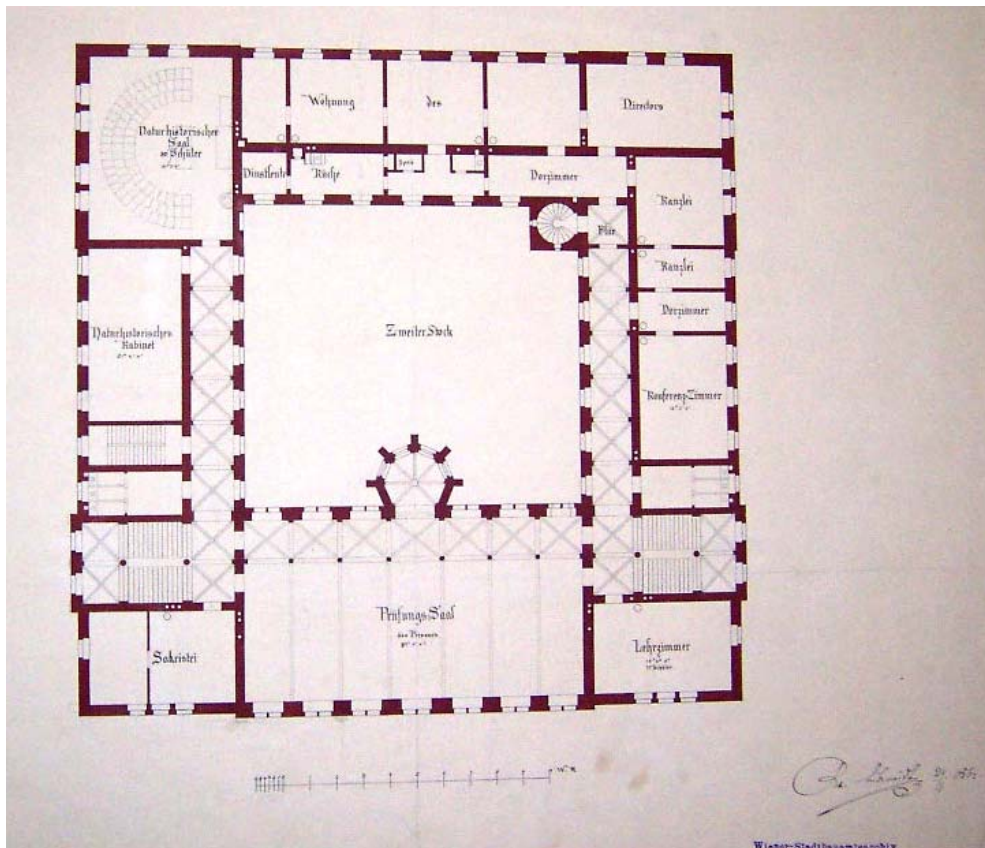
Grundrissplan, Zweiter Stock, 1862
